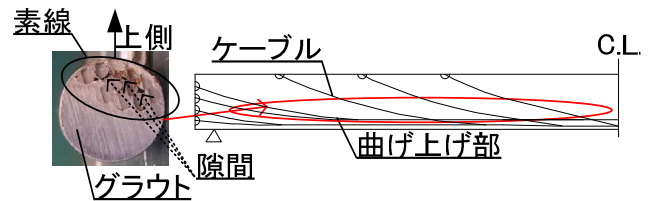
主桁の主ケーブル配置図および曲げ上げ部の主ケーブル(シース)断面図
